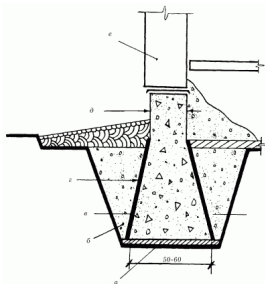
Устройство бетонного или бутобетонного фундамента в условиях тяжелых грунтов: а – уплотненный грунт или щебень; б – обратная засыпка; в – глубина промерзания грунта; г – обмазка; д – бетон или бутобетон; е – каменная стена.
